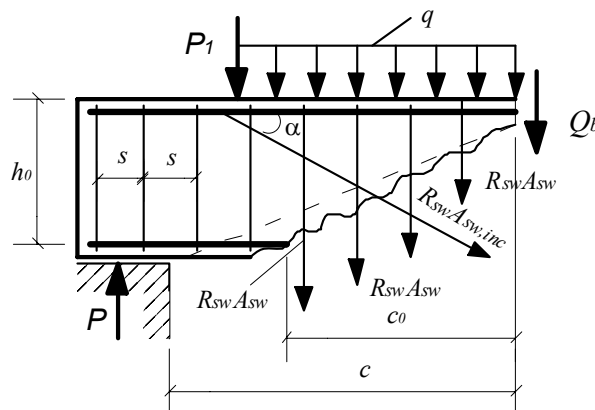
Розрахункова схема внутрішніх зусиль у похилому перерізі
